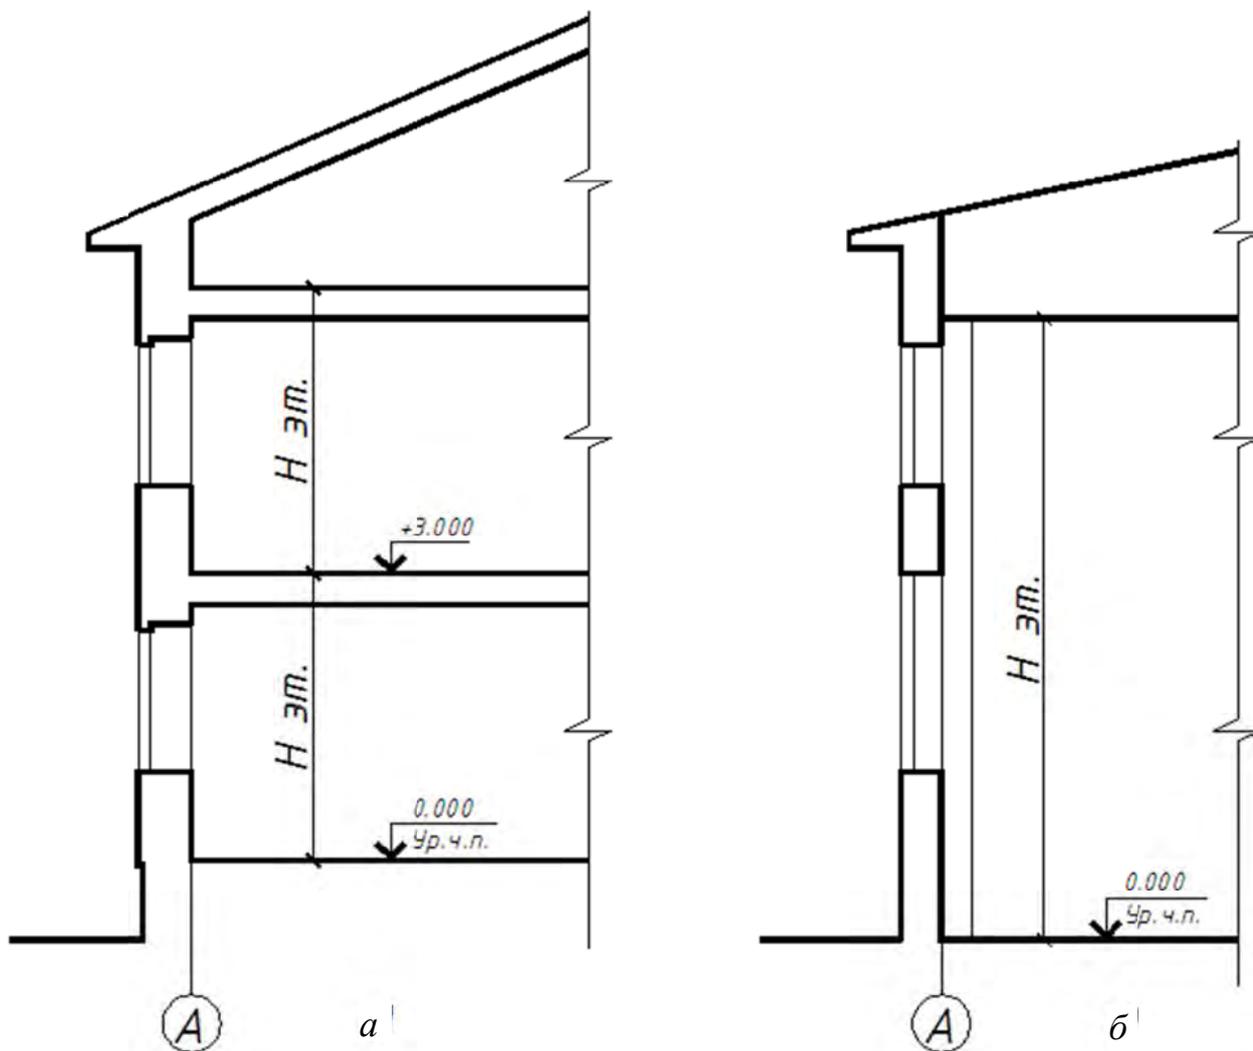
Высота этажа: *а* – жилого здания;
